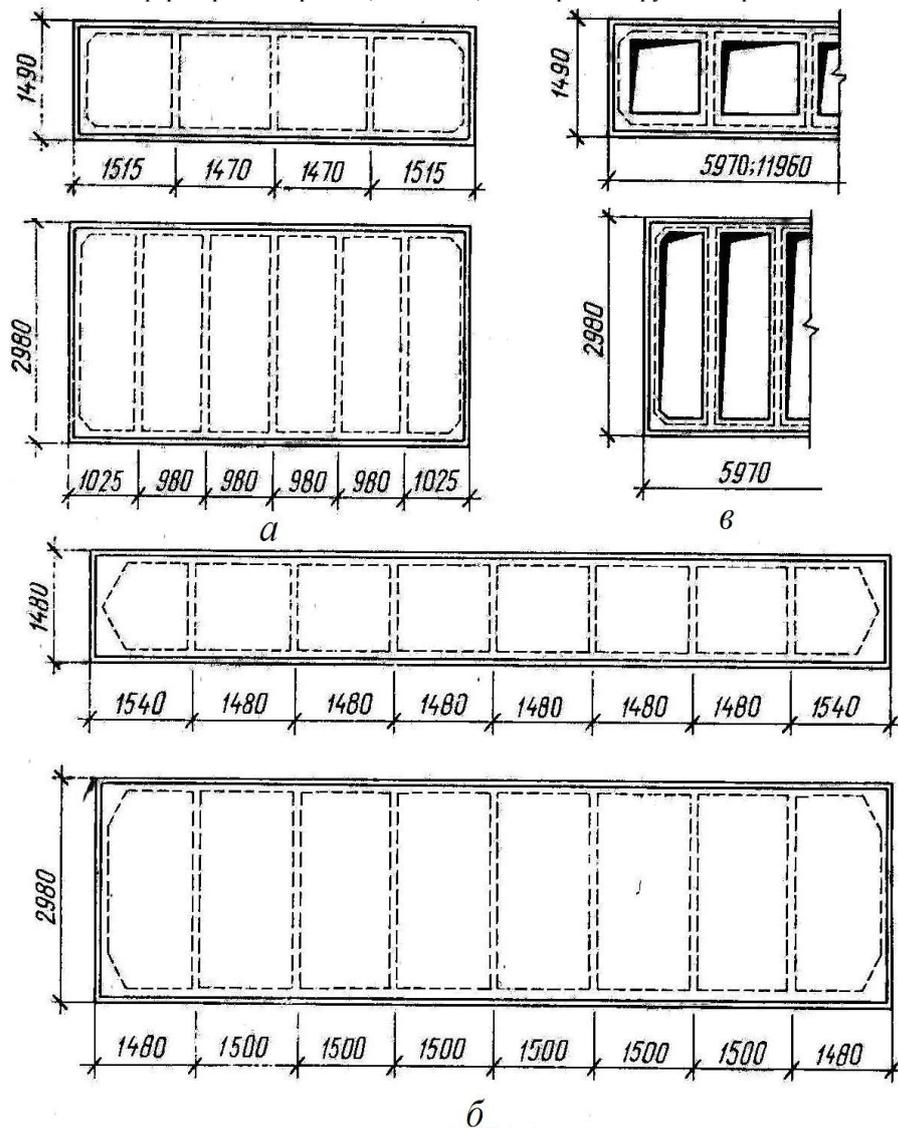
Железобетонные ребристые панели покрытия промышленных зданий:
